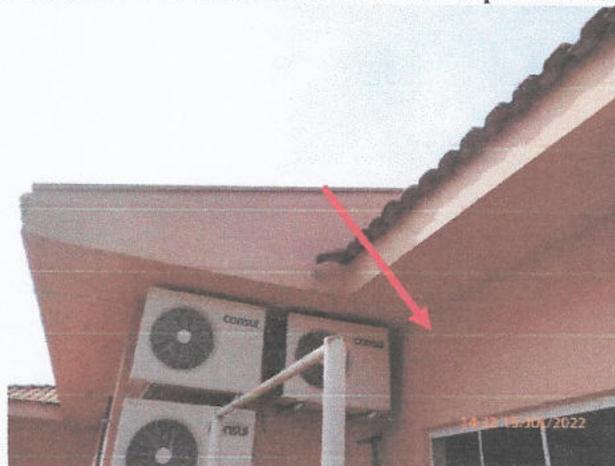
Infiltração aparente em laje do alojamento 1 - pav. superior
